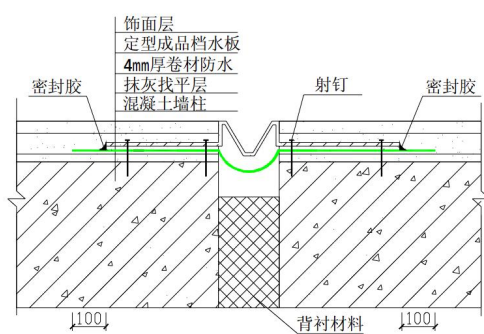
墙面变形缝做法有保温层做法示意图
